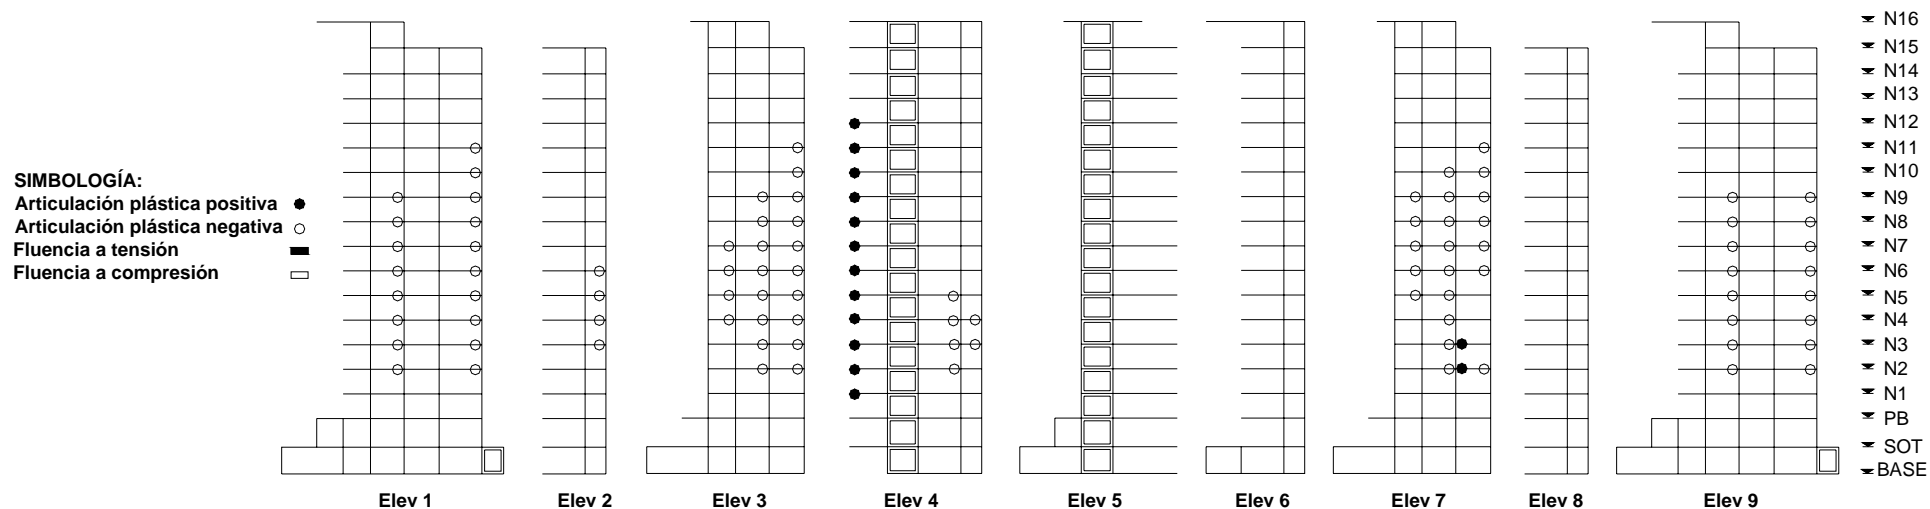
Formación de articulaciones plásticas en vigas y columnas para la SIM64 a los 53.63 s
